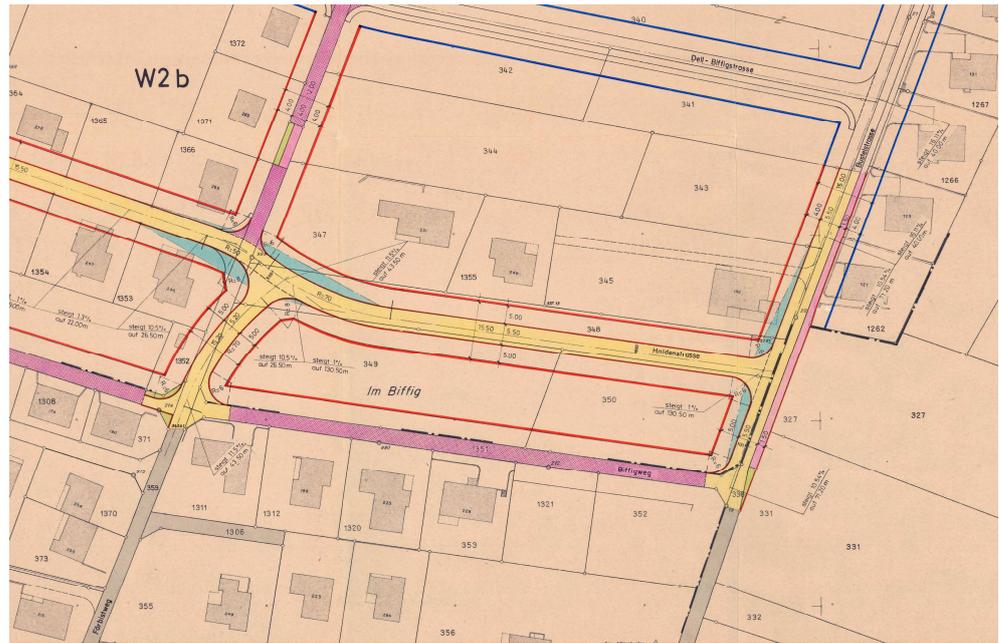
Ausschnitt aus dem Überbauungsplan Münchwilen Ost mit der geplanten, aber nie realisierten Haldenstrasse
